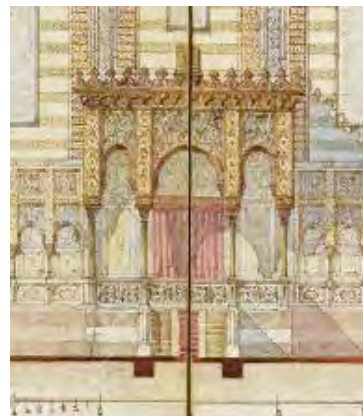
Planmaterial Adolf Zeligson Ausschnitt Querschnitt
